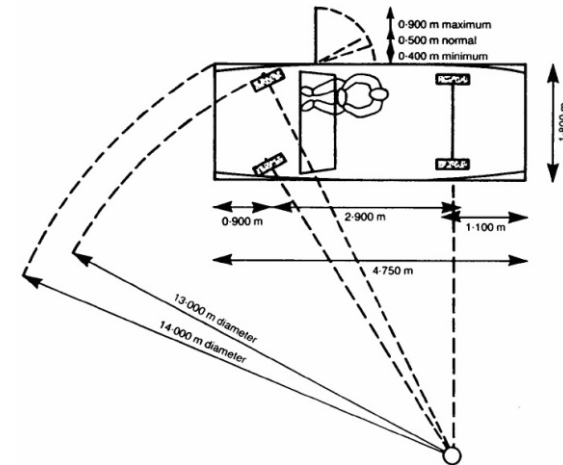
Rancangan sirkulasi kendaraan dalam site.
